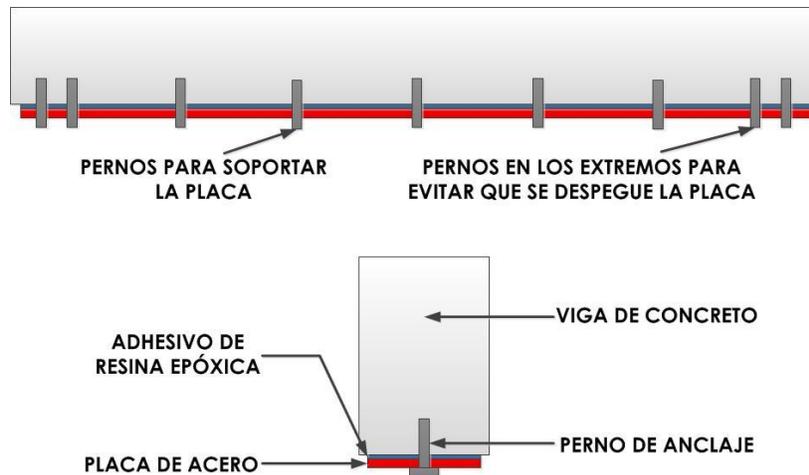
Diseño del refuerzo con placas de acero (Ryall, 2001)
